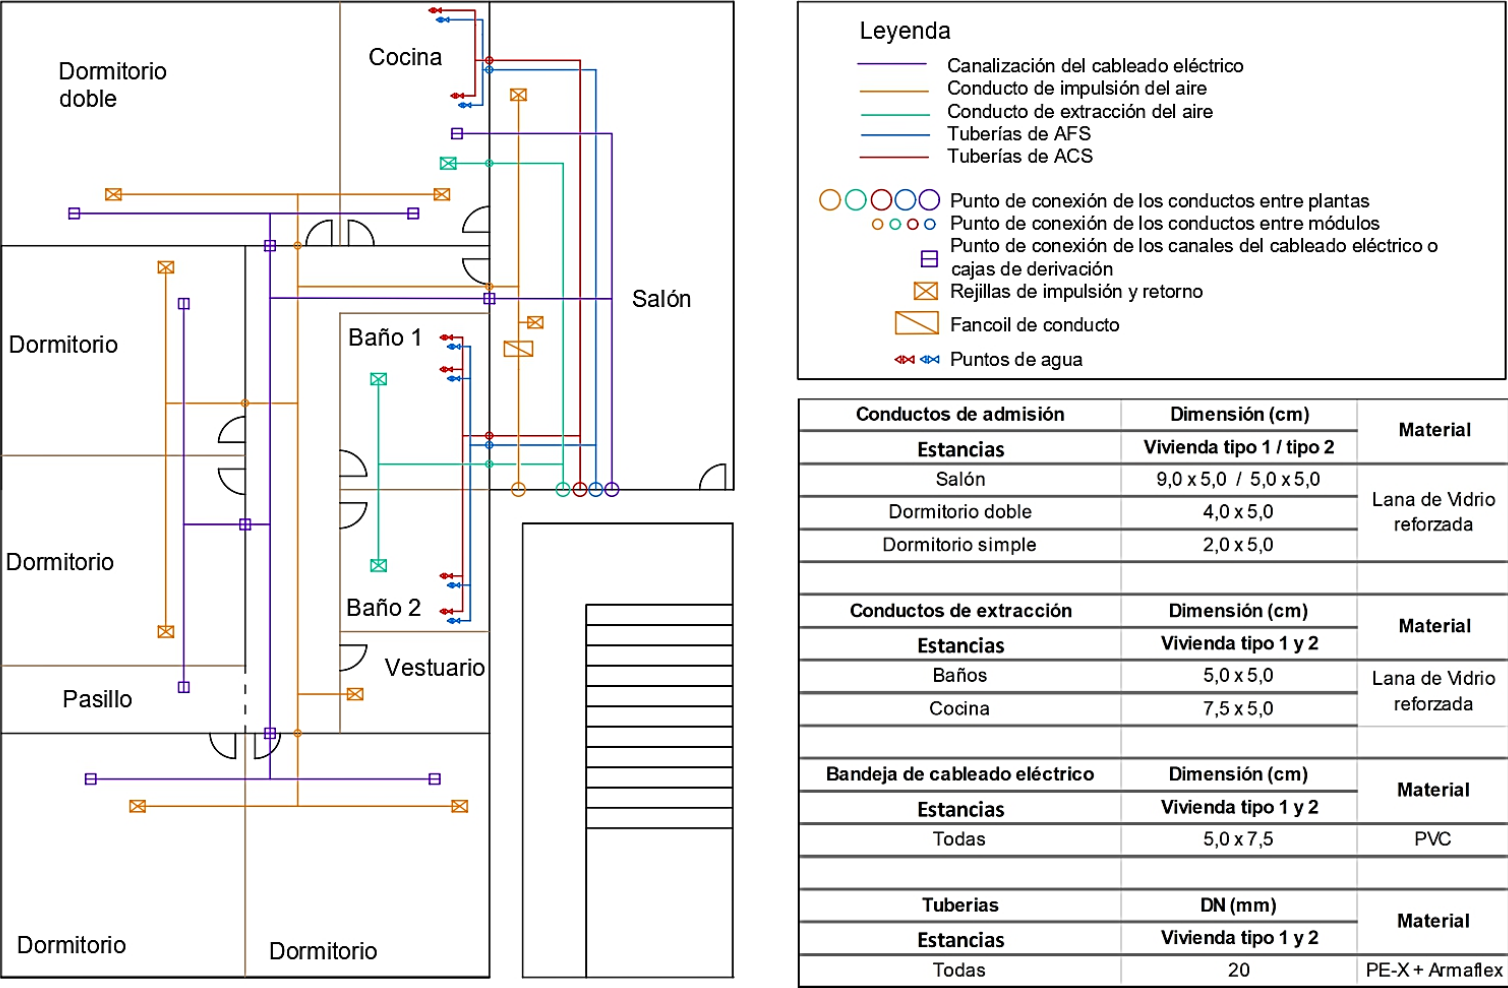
Plano del paso de las instalaciones en la vivienda tipo 2. Fuente: Elaboración propia.
